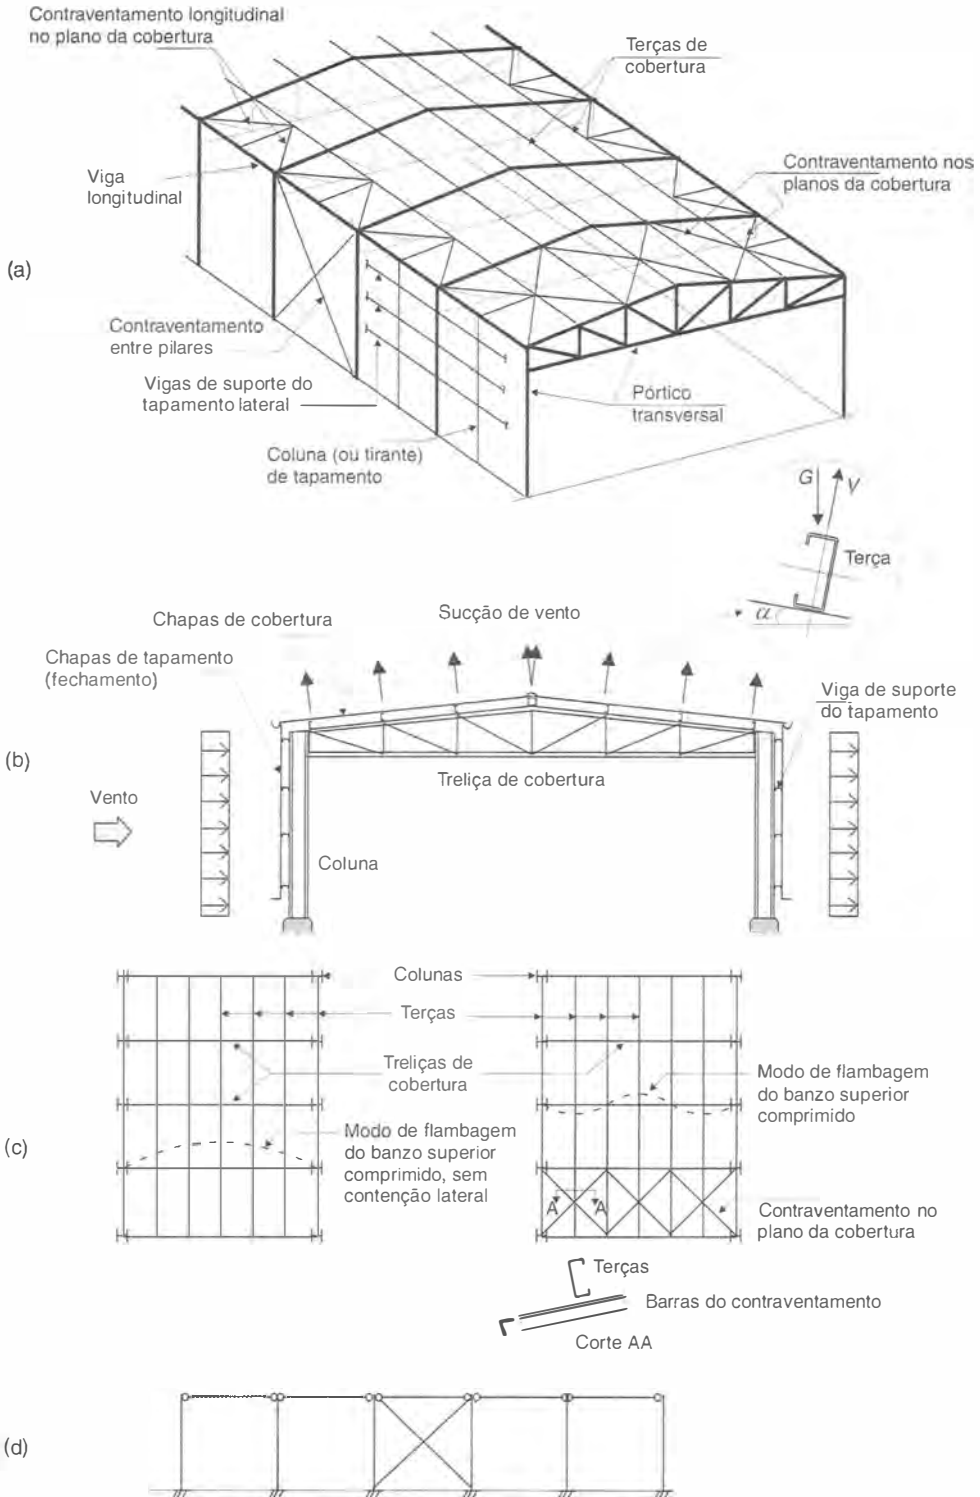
Galpão metálico: (a) esquema tridimensional; (b) pórtico transversal sob ação do vento. No detalhe, terça sob flexão oblíqua; (c) planta da cobertura sem e com contraventamento; (d) vista longitudinal mostrando o contraventamento entre pilares.
